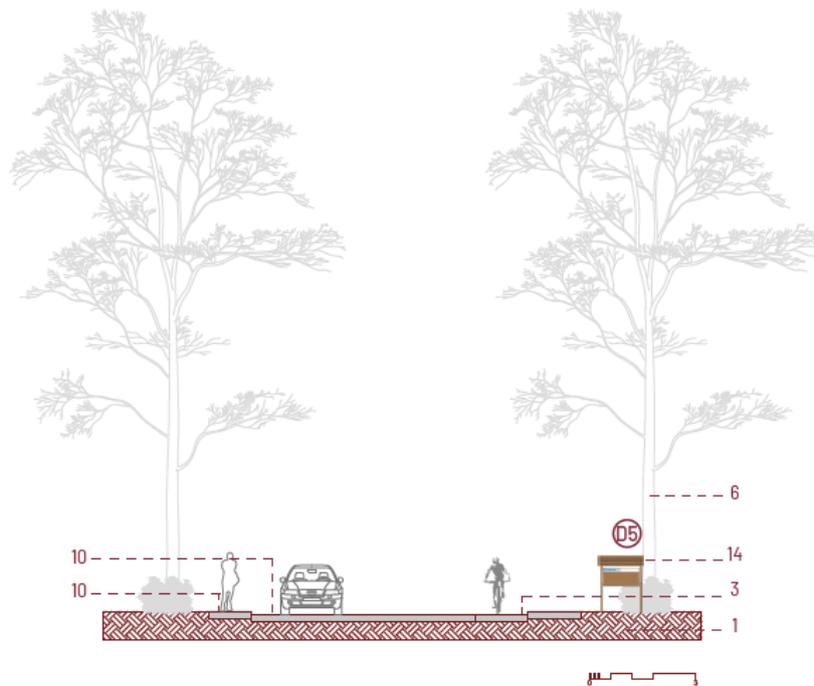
Vista en Planta y Sección de la vía Vehicular y detalle de la cuneta
